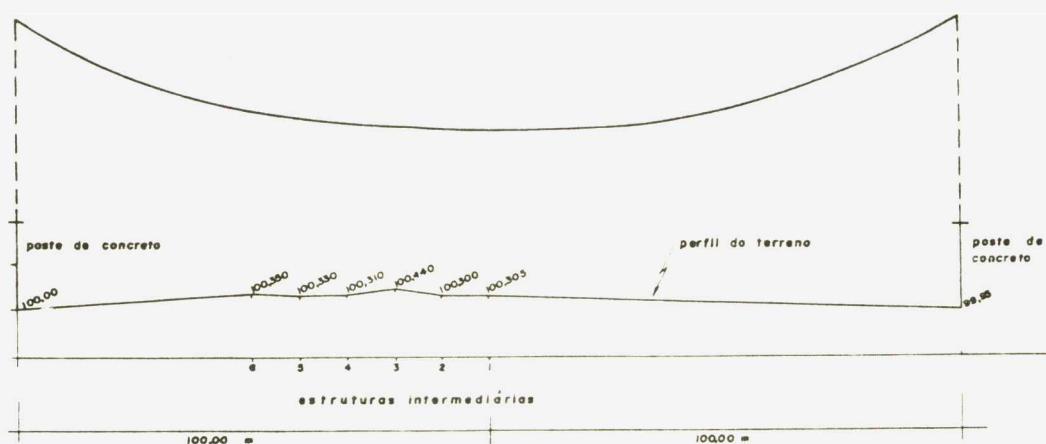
Disposição das estruturas para ensaio de arrancamento
